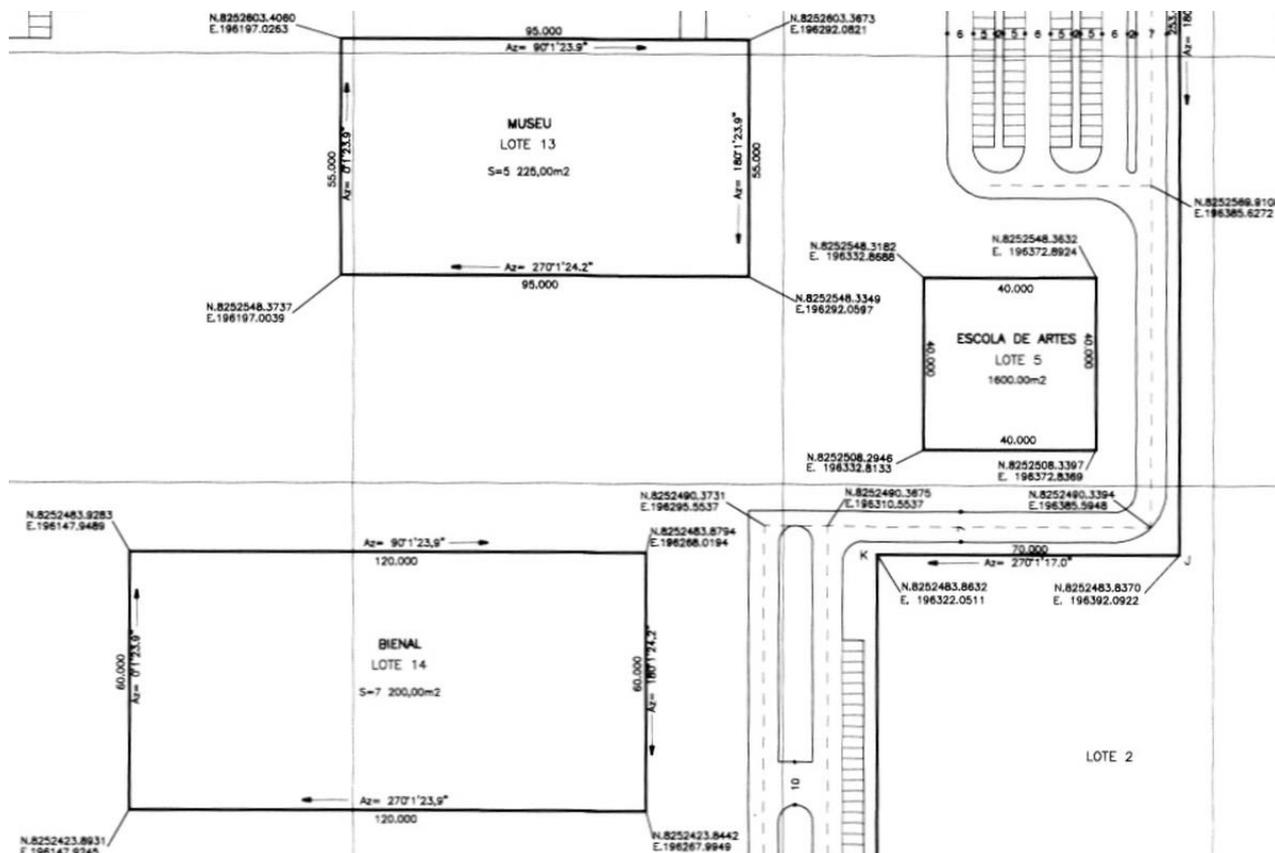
Trecho da URB 79/96 – Planta Parcial 5/5
